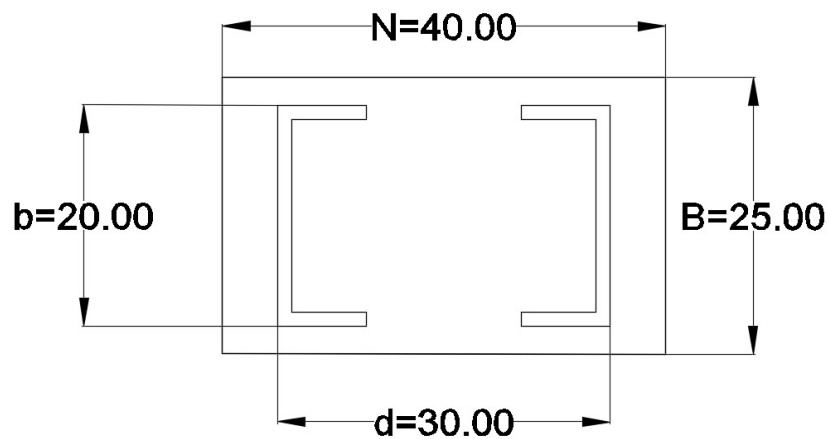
Vista en planta de una columneta con los perfiles de acero de columna de pórtico
